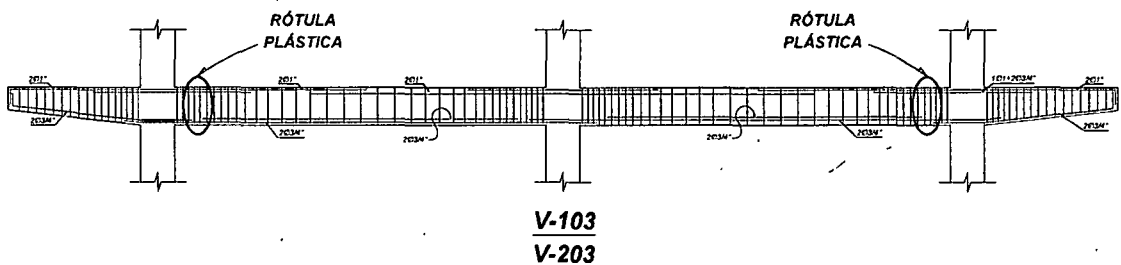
Ubicación de las rótulas a analizar en las vigas V-103 y V-203
